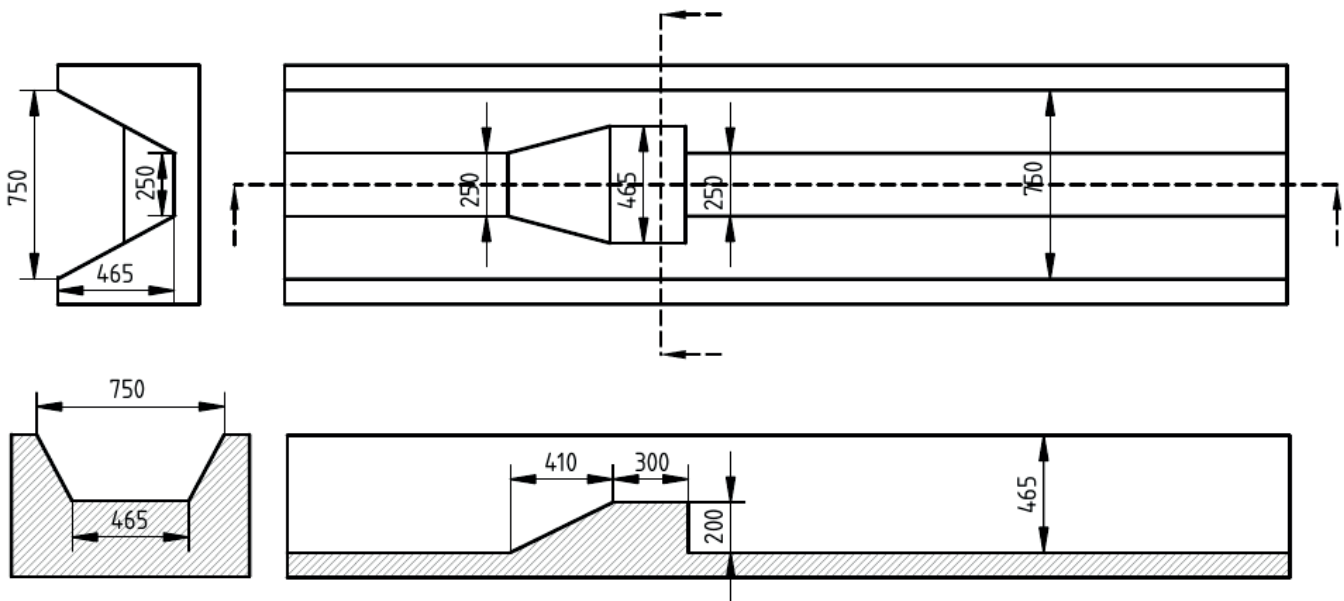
| Plano del aforador ensayado en laboratorio (cotas en mm): vista lateral (arriba-izquierda), planta (arriba-derecha), sección transversal (abajo-izquierda), sección longitudinal (abajo-derecha).
